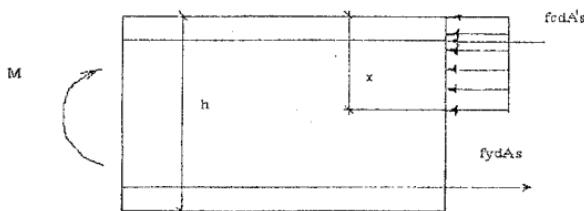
Расчетная схема элемента с двойным армированием
